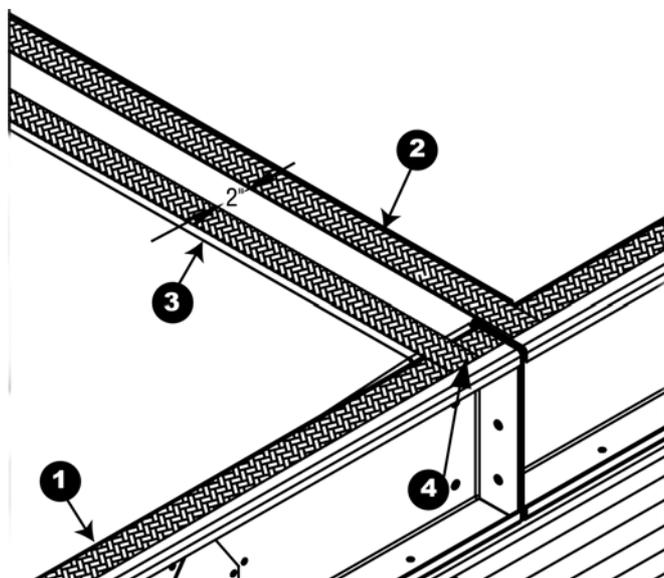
Détail de la vue A – Chevauchement des joints d'étanchéité
